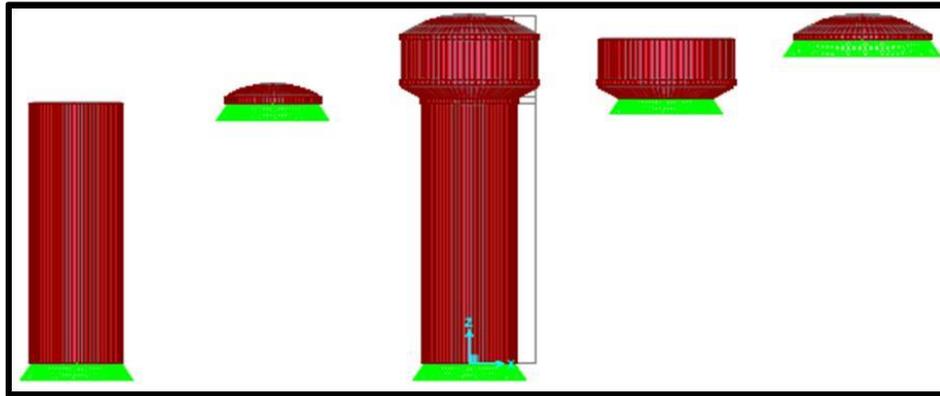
Modelamiento por separado de elementos estructurales del Reservorio de Tanque elevado
